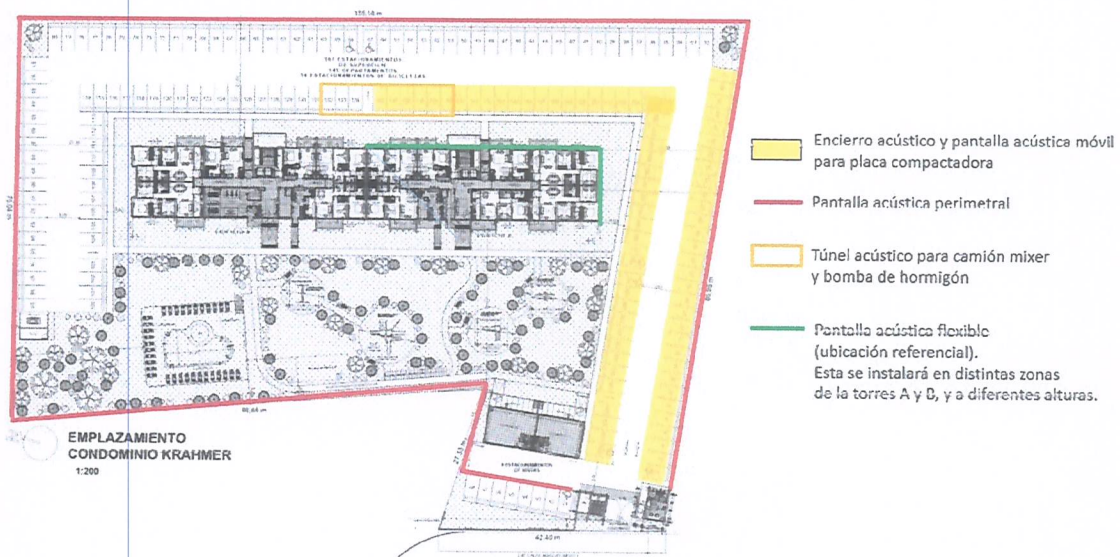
Ubicación de soluciones de control de ruido en plano de planta del Proyecto.
